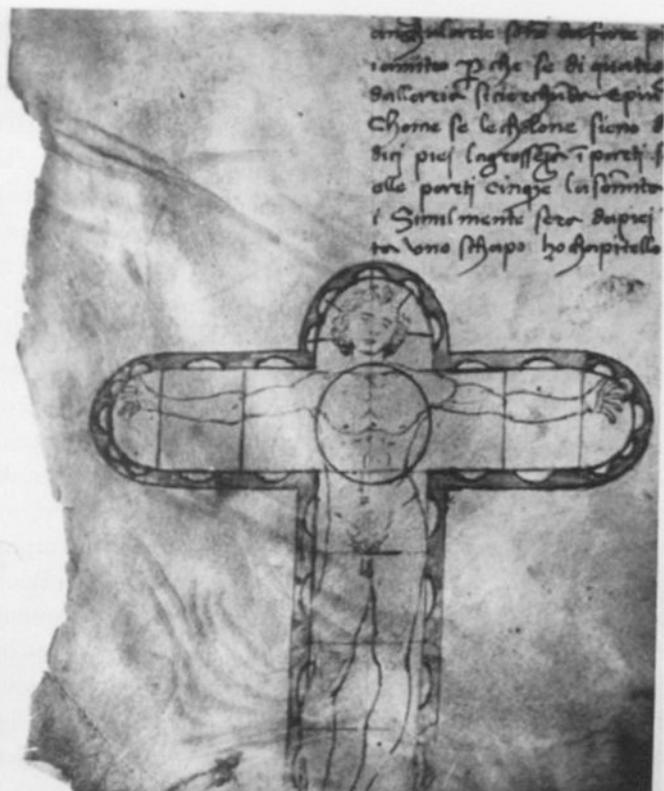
Francesco di Giorgio Martini, Proportionsfigur mit Grundriss
